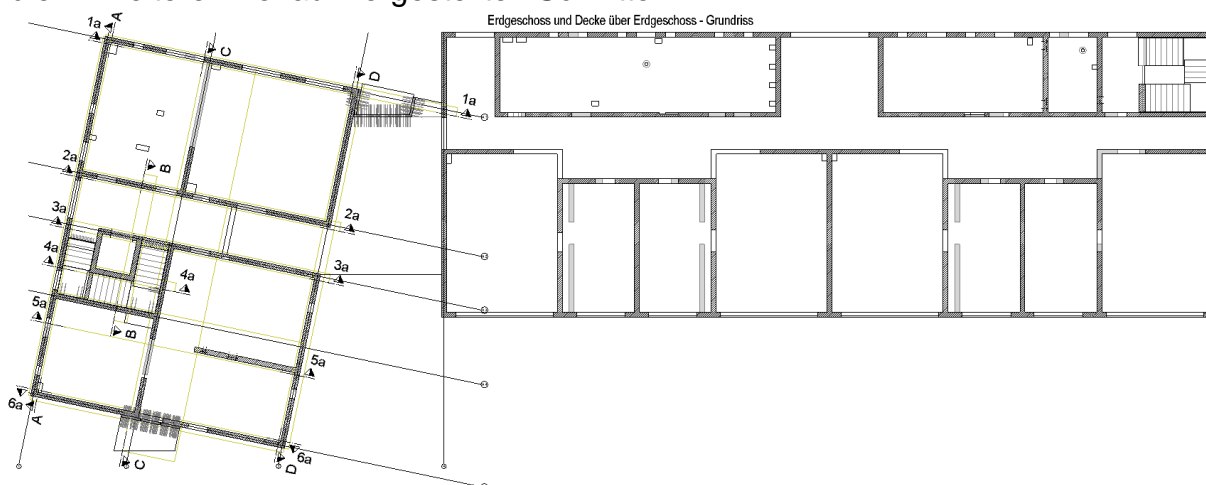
Grundrissdeckenuntersicht des Erdgeschosses mit den Schnitfführungen der im Plan 9 abgebildeten Ansichten
